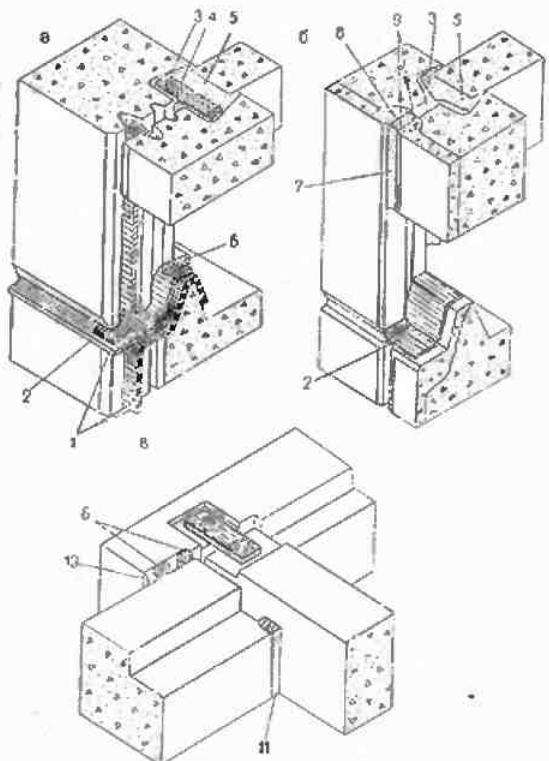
Вертикальныестыки наружныхстен крупнопанельных зданий
